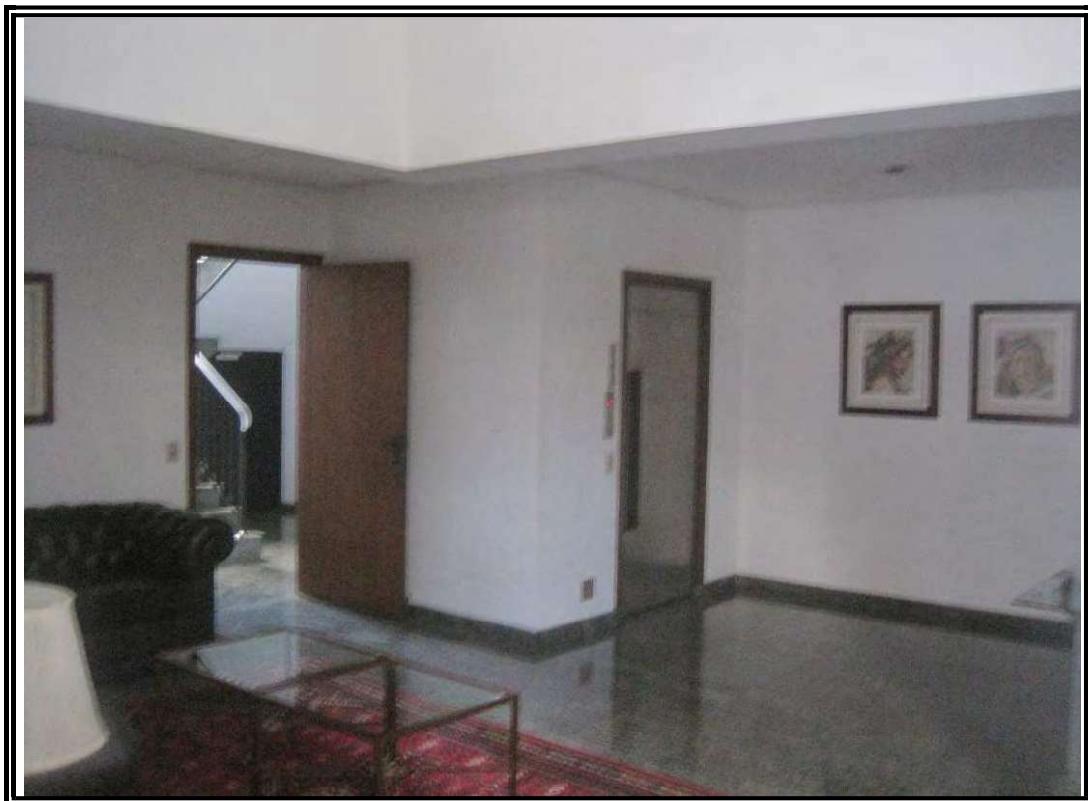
Vista do hall de entrada do Condomínio Edifício Tupanuyara
